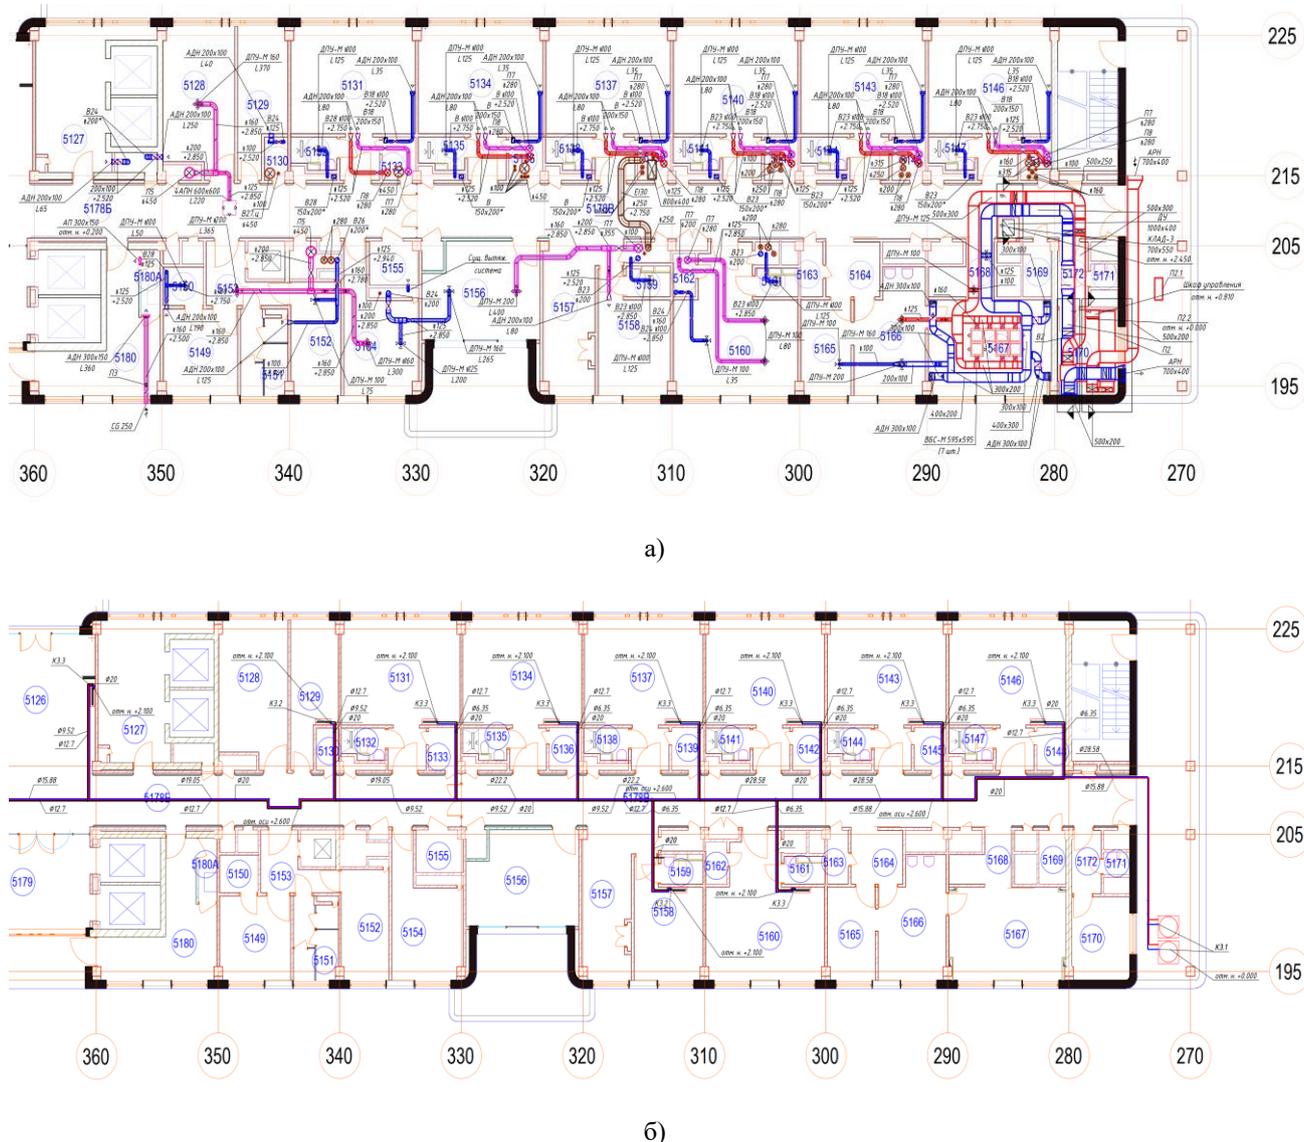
Системы вентиляции (а) и кондиционирования воздуха (б) пятого этажа здания
